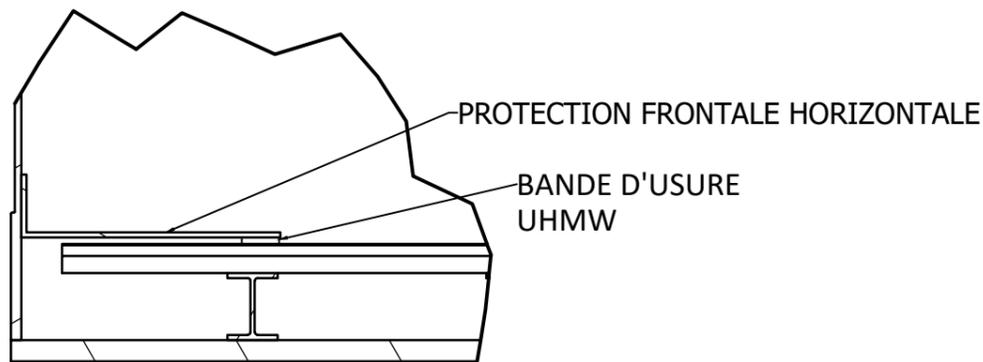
INSTALLATION DE LA PROTECTION FRONTALE HORIZONTALE
